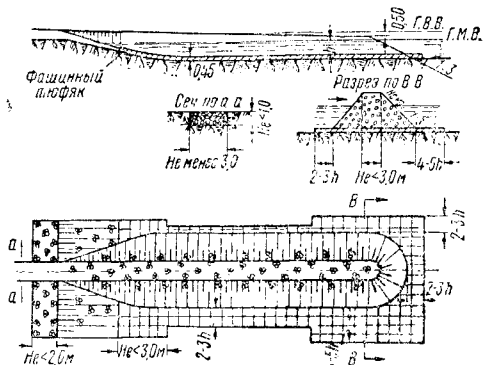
Укрепление основания стенки наброской бетонных массивов
